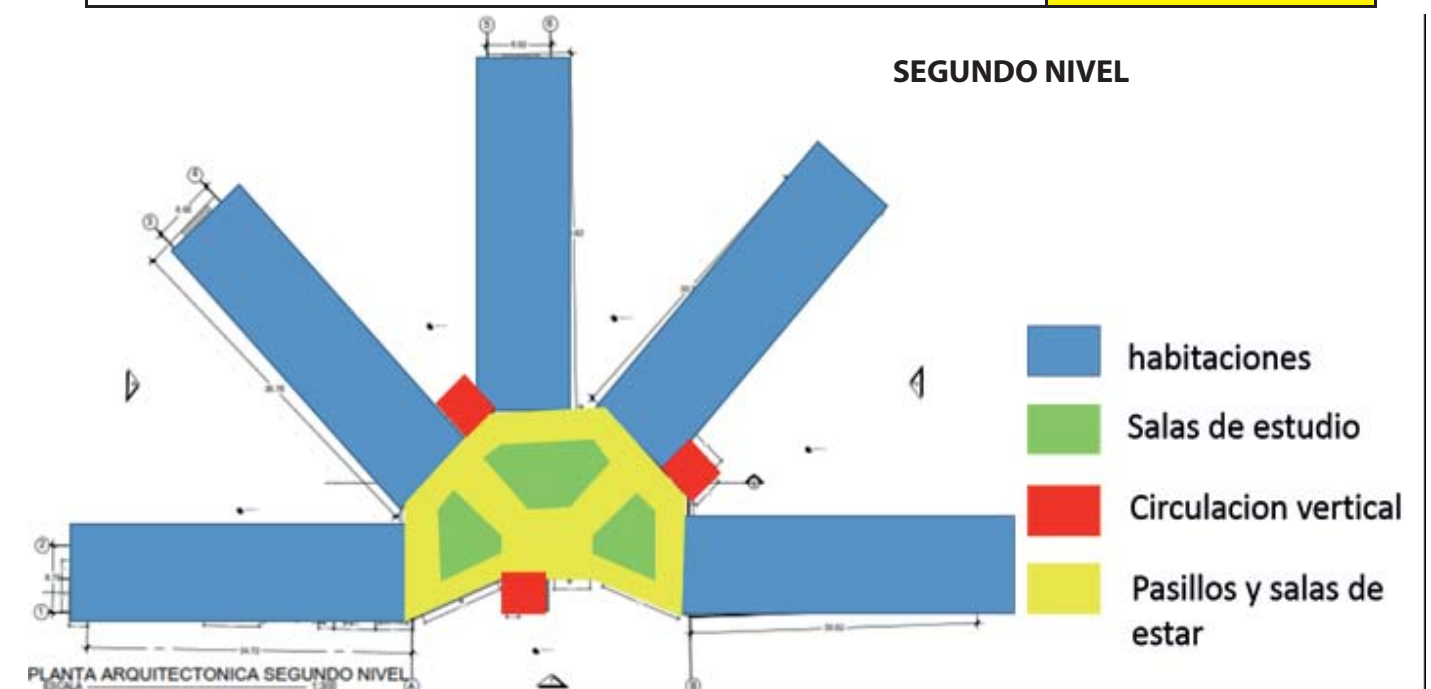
Distribución de la planta arquitectónica del segundo nivel
